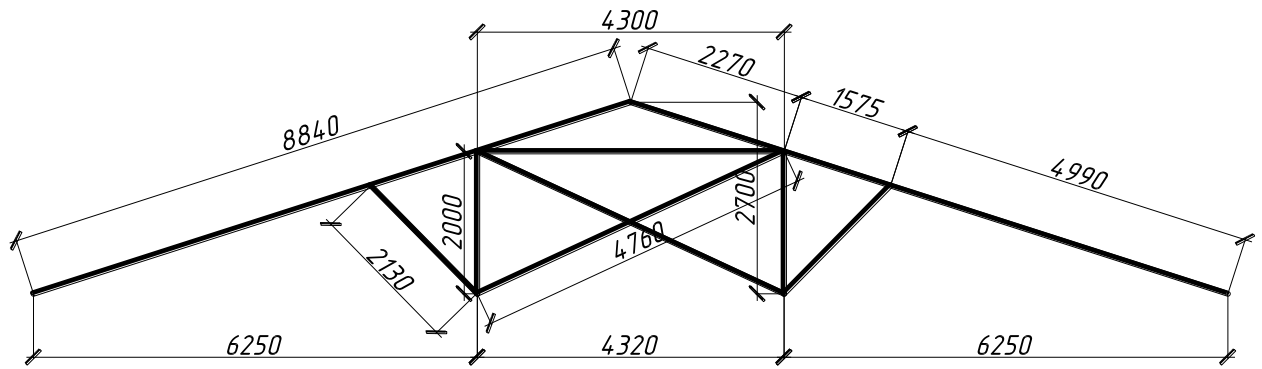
Геометрическая схема деревянной стропильной конструкции
